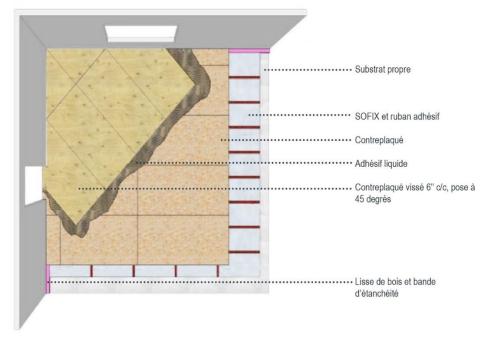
Schéma d'installation des panneaux SOFIX ©AcoustiTECH
